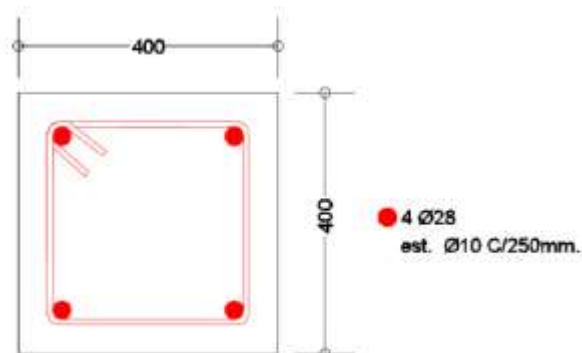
Armado general de Columnas (planta baja a losa de 2do piso del Edificio). Fuente: (Loor, 2015)
